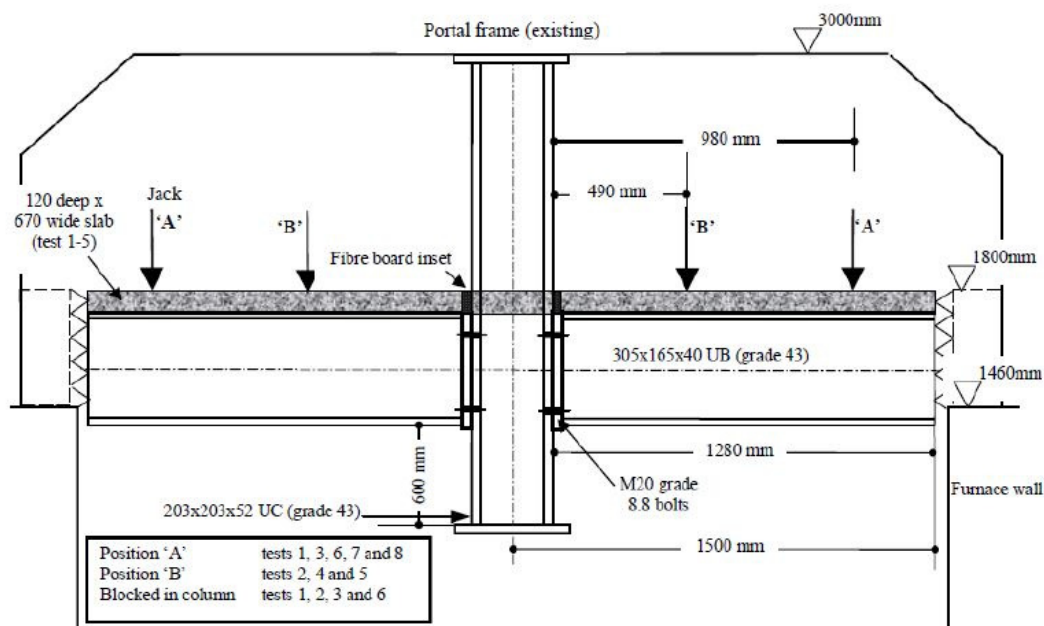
Modelo de ligação viga pilar utilizado nos ensaios experimentais (LAWSON, 1990).
